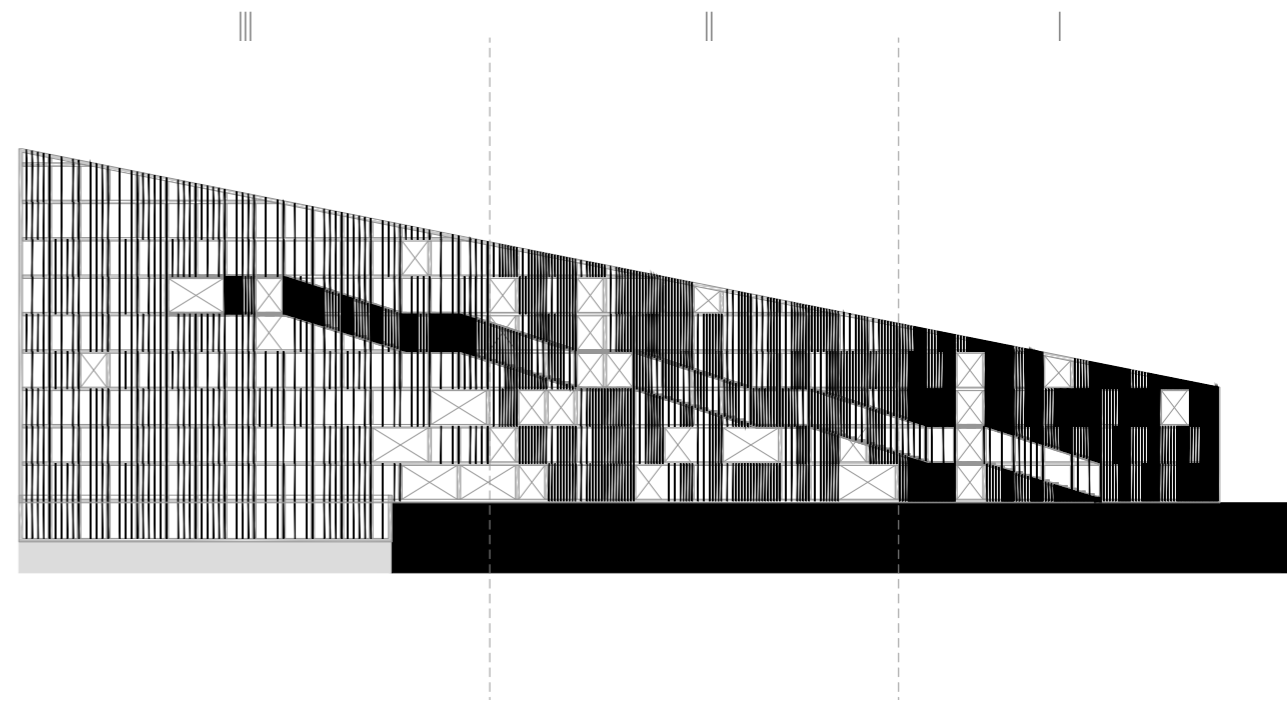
| 139 - Fachada norte e sul, respetivamente.
